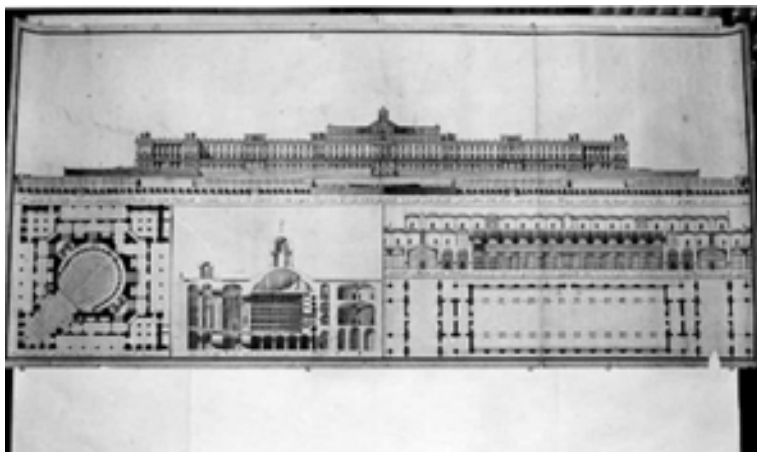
Prospetto di un lato della Reggia di Caserta; pianta del teatro; spaccato del teatro; spaccato e pianta della Biblioteca
